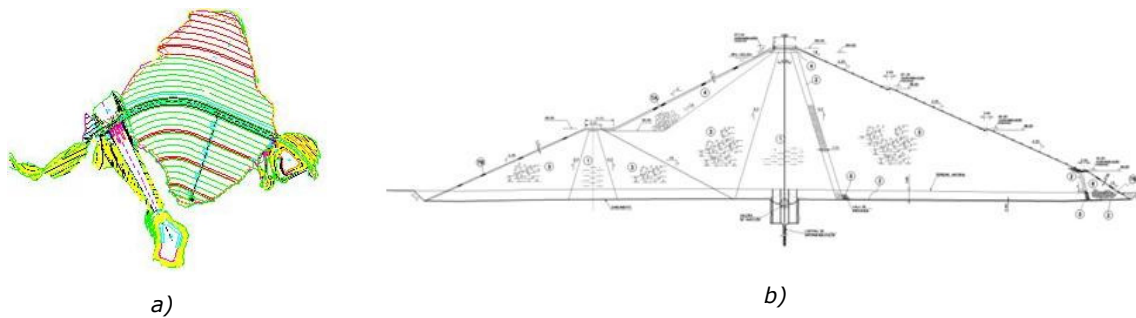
a): Planta geral e b): Perfil tipo da Barragem de Odelouca
